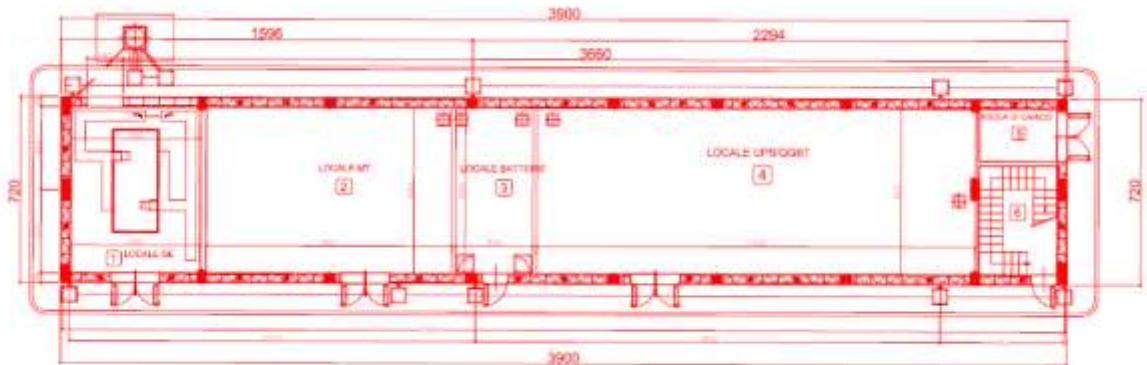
Pianta piano terra del fabbricato nel Progetto di variante.
